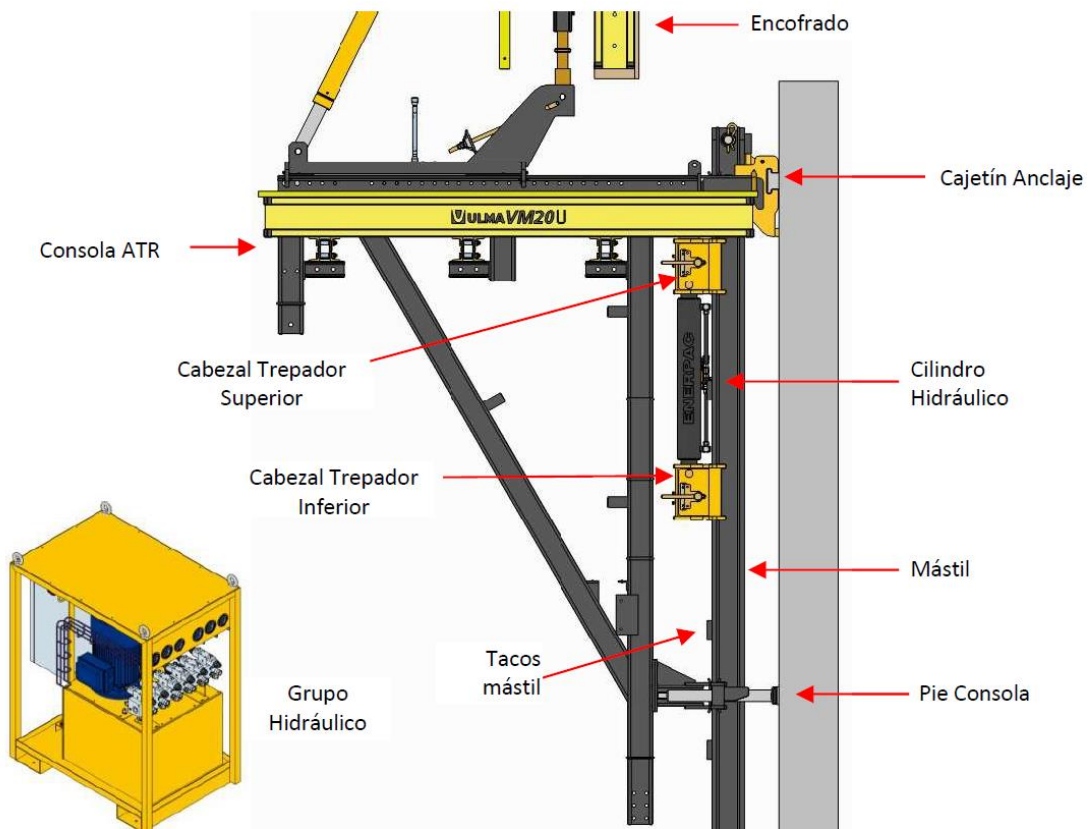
Componentes de la plataforma principal de trabajo. Recuperado de: Ulma Construction, *Consolas autotrepantes*.
